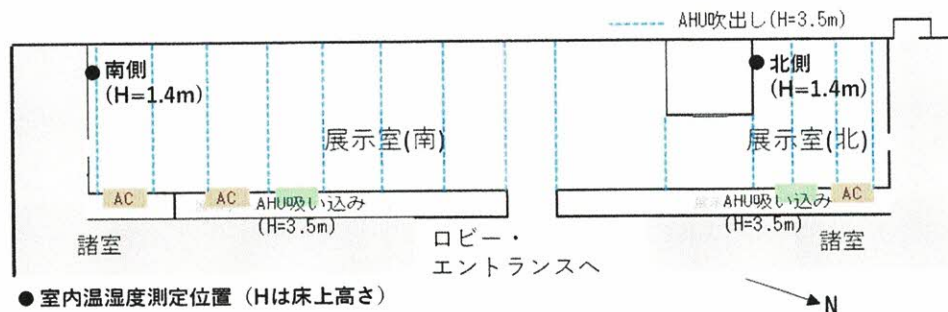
展示室周辺の平面図と温湿度ロガーの設置位置（地上2階）
